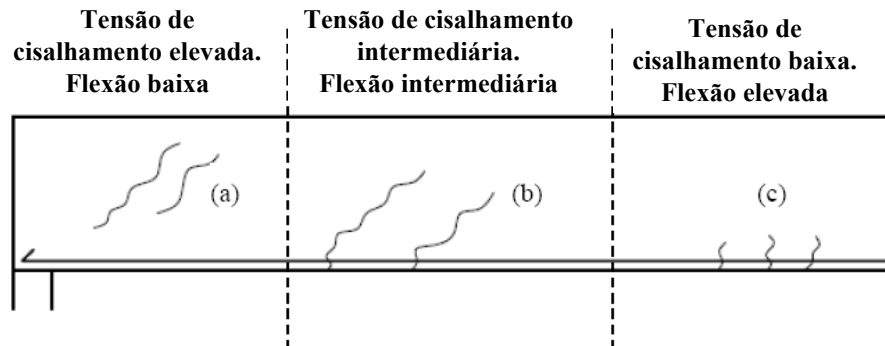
Elemento de concreto protendido submetido a flexão e cisalhamento. a) Fissuras na nervura devidas o cisalhamento; b) Fissuras de cisalhamento e flexão; c) Fissuras de flexão [Rettne e Edekling (2006)].
